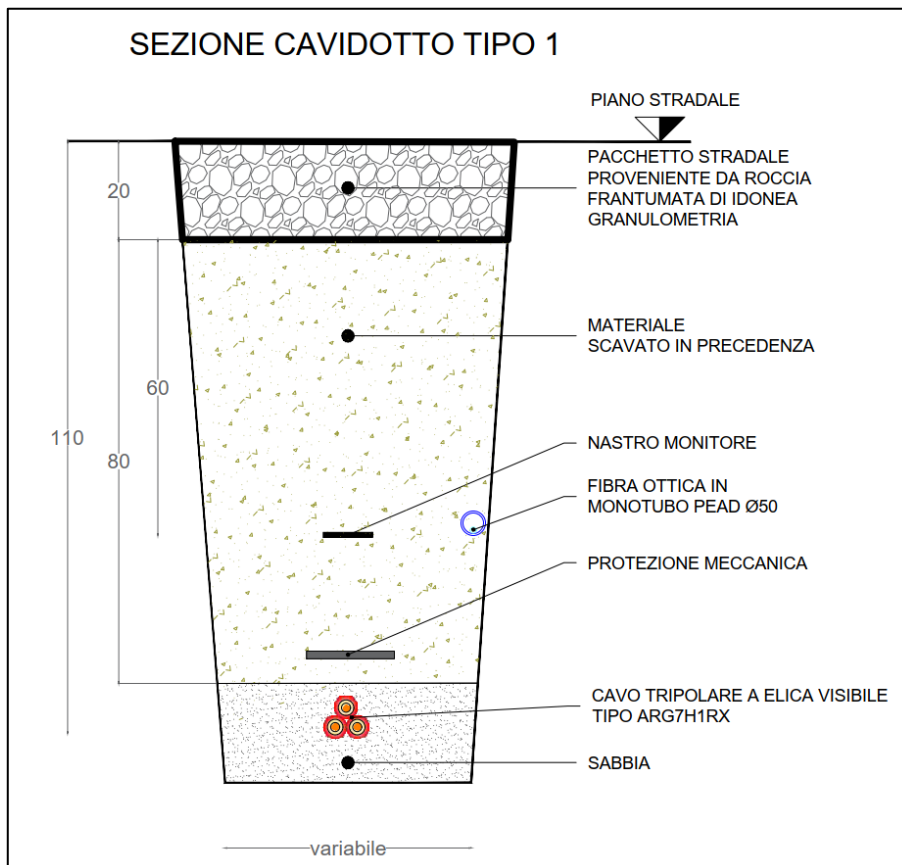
Sezione di posa cavidotto MT a 30 kV – tipo 1
